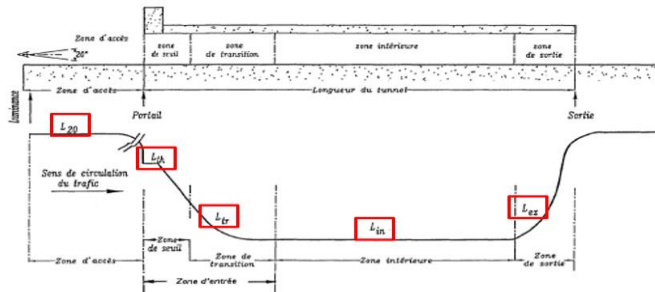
Coupe longitudinale typique dans un tunnel à circulation unidirectionnelle
